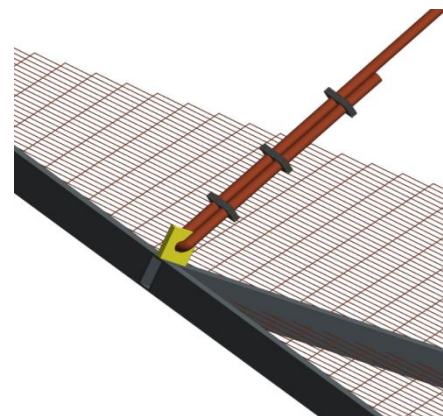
钢丝绳与安全外挑防护网连接示意图
